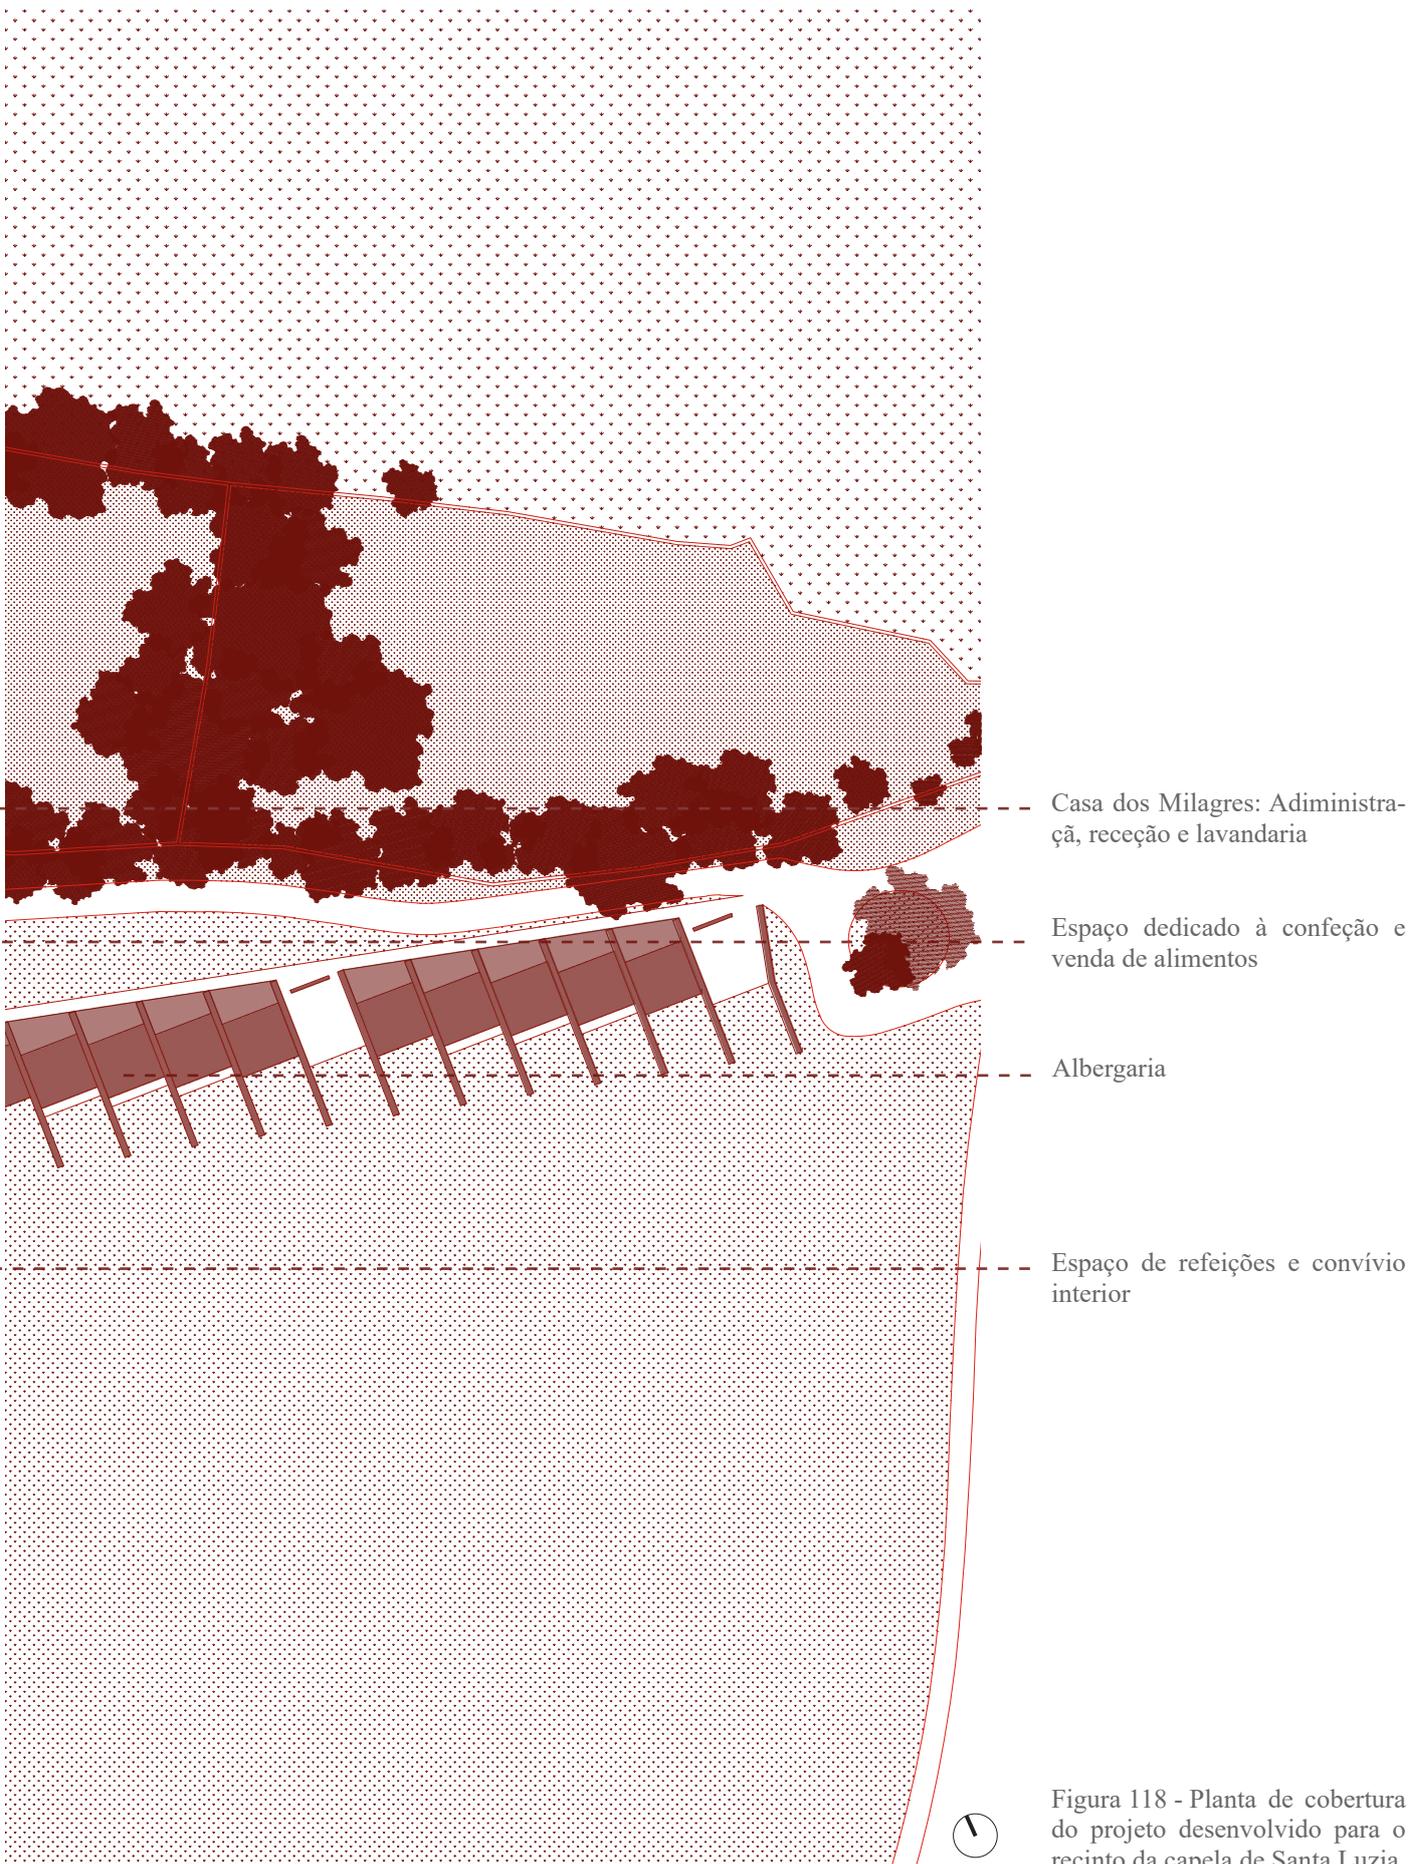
Planta de cobertura do projeto desenvolvido para o recinto da capela de Santa Luzia
